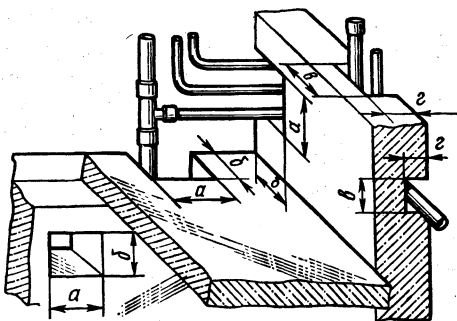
Отверстия и борозды для прокладки трубопроводов
